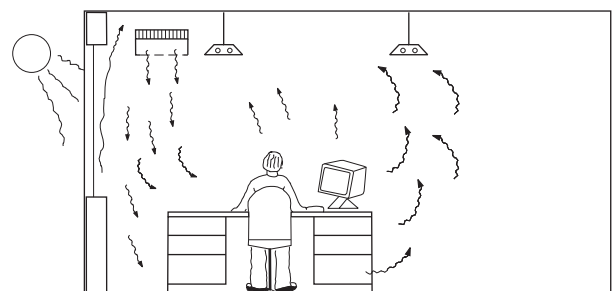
Convecteur de refroidissement de plafond contre la façade
